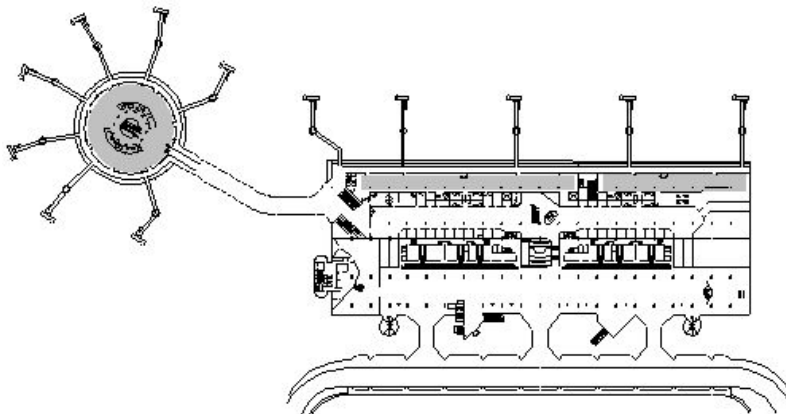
Planta esquemática do AIB / 1º Pavimento – em destaque o salão de embarque e o satélite.
